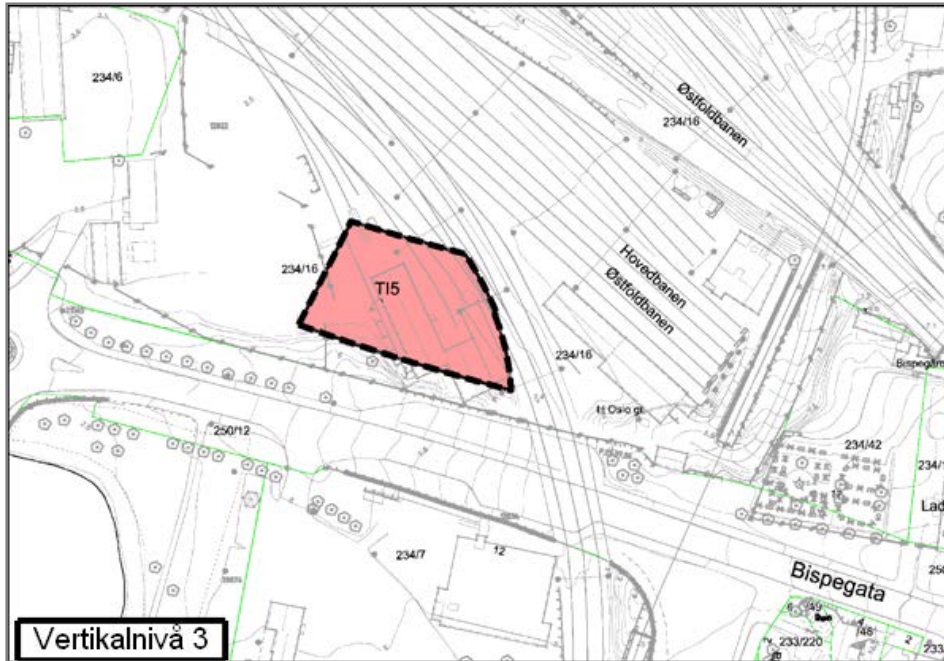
Eksempel på utsnitt av plan over flere vertikalnivå (tegnforklaringen er ikke fullverdig).
